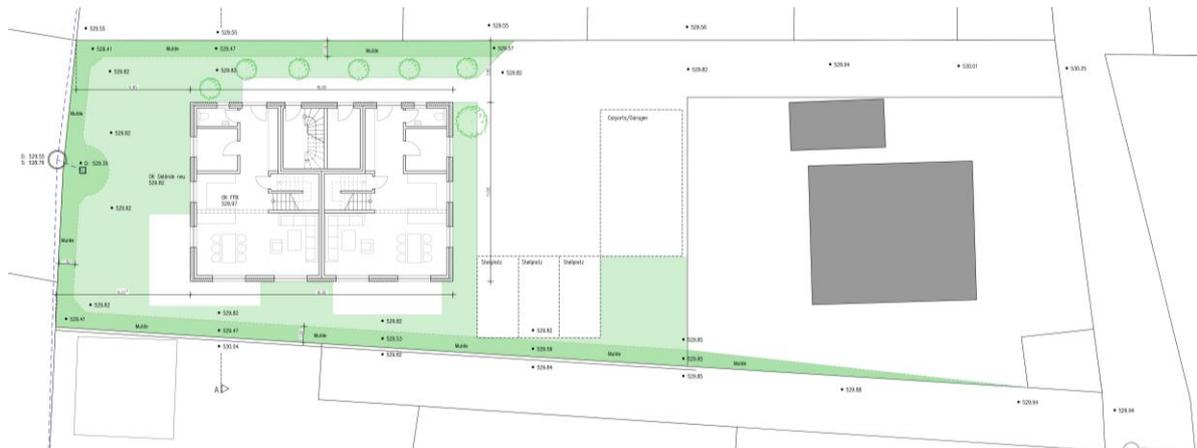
Auszug aus Muldenplan zur Errichtung eines Dreifamilienhauses, Stand 02.06.2023 – ohne Maßstab
